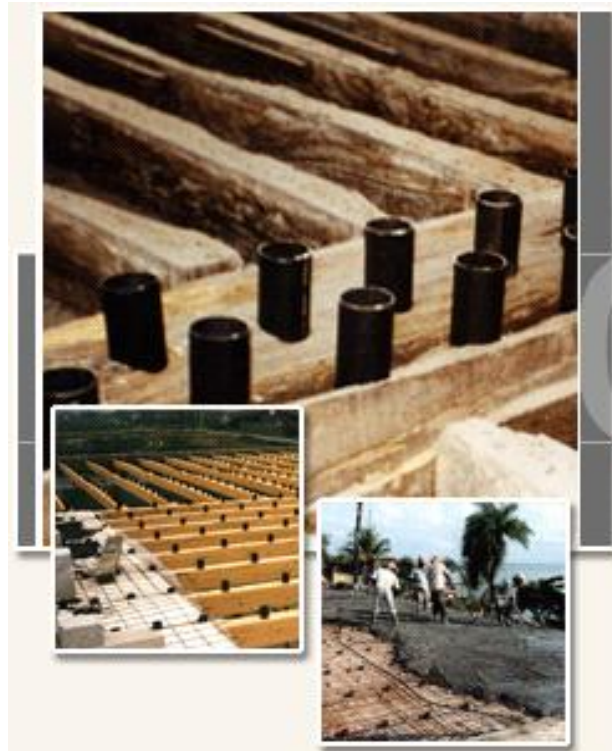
Prédalle de bois munie de connecteurs avec ferrailage, bac acier et isolant
